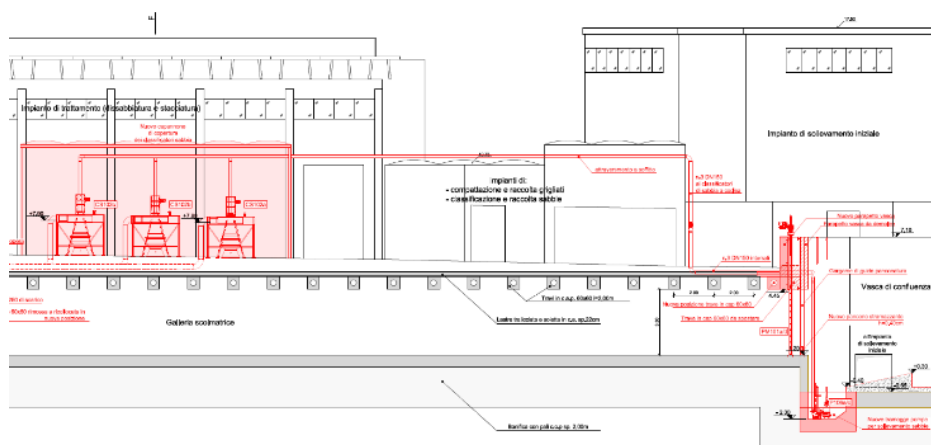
Estrazione e trattamento delle sabbie dalla vasca di confluenza – Sezione
